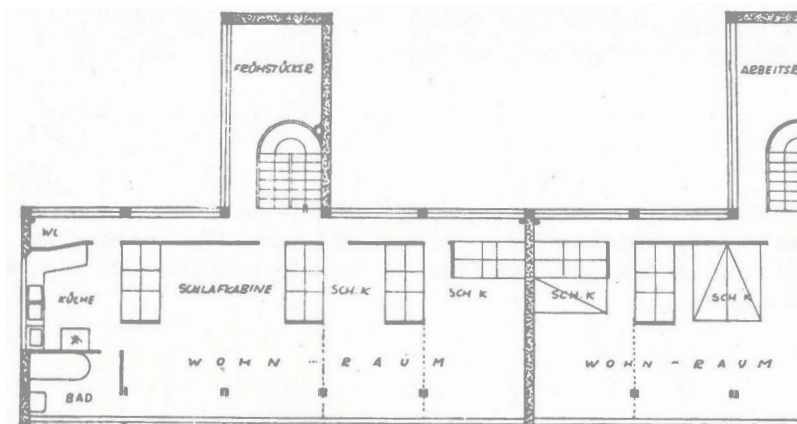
Le Corbusier, Doppelwohnhaus Weissenhof, 1927, Grundriss M. 1:200
